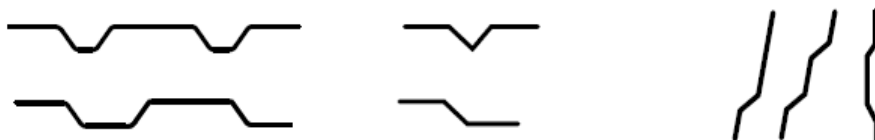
Exemples de tôles ondulées pour les toitures, revêtements muraux et planchers
